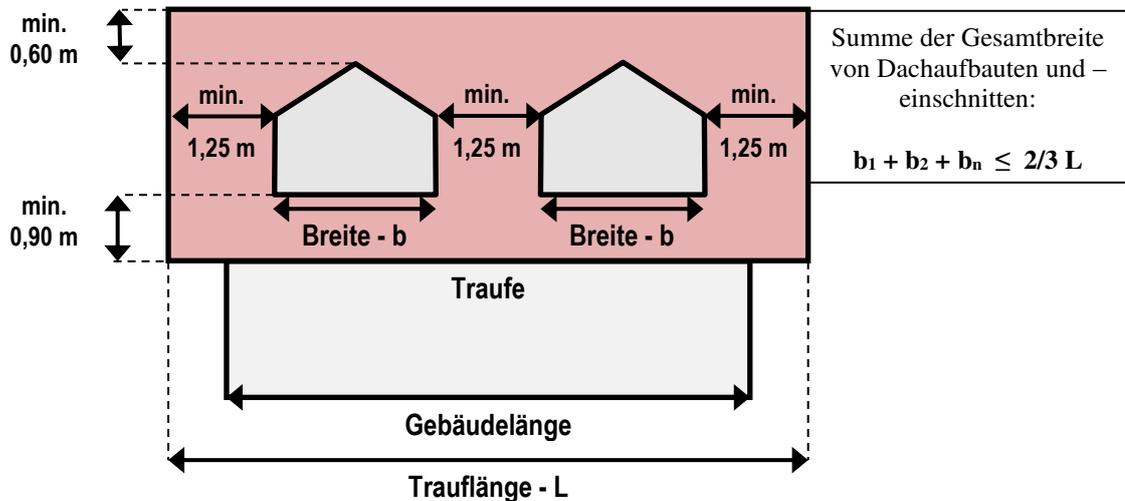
Abmessungen / Abstände zulässiger Dachgauben (Bsp.: Sattelgaube)
